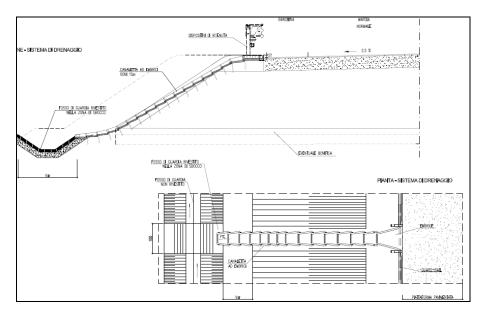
PARTICOLARE CANALETTE AD EMBRICE
